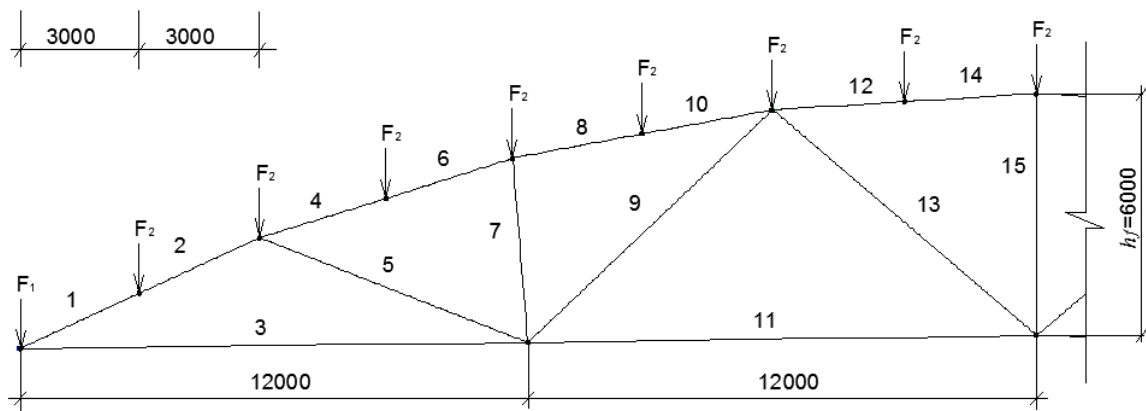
Стальная полигональная ферма с прямыми стержнями панели верхнего пояса
